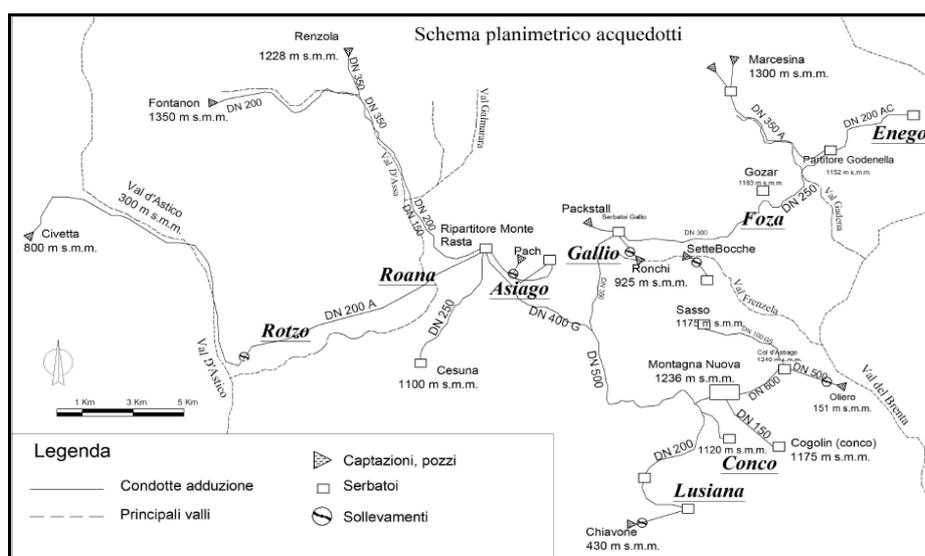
Planimetria delle opere di adduzione, (Fonte: Allegrini, 2005)
